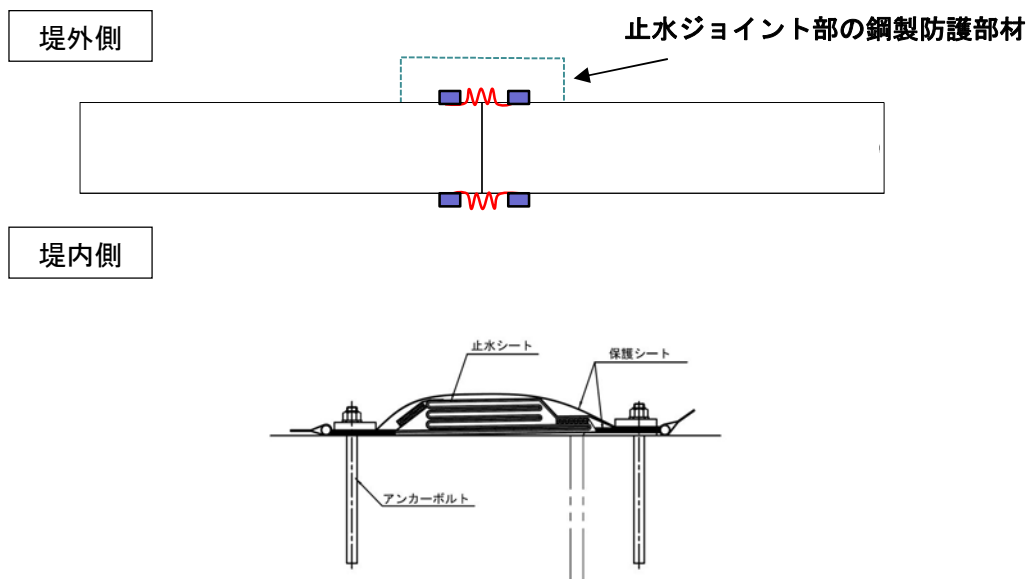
鉄筋コンクリート防潮壁 平面図
